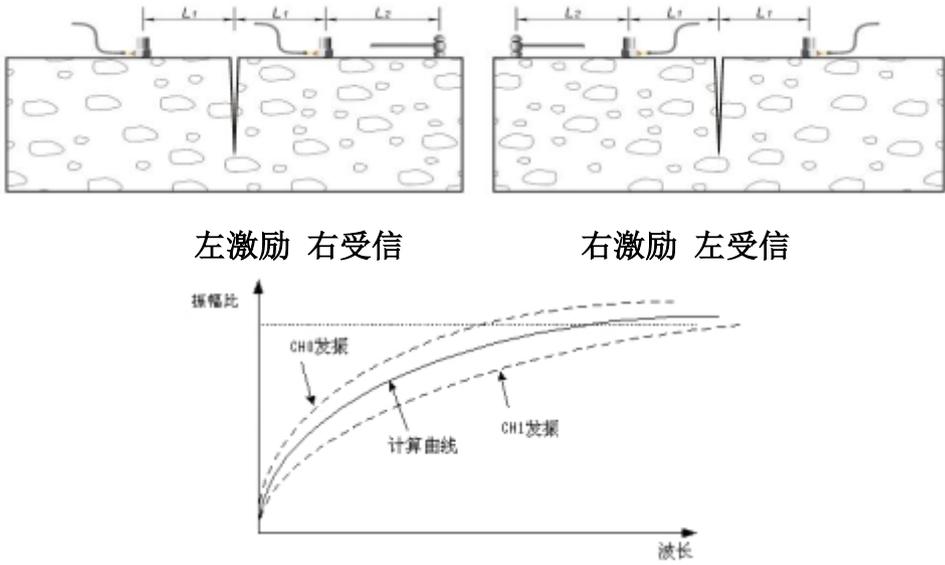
混凝土裂缝深度测试（表面波法）
